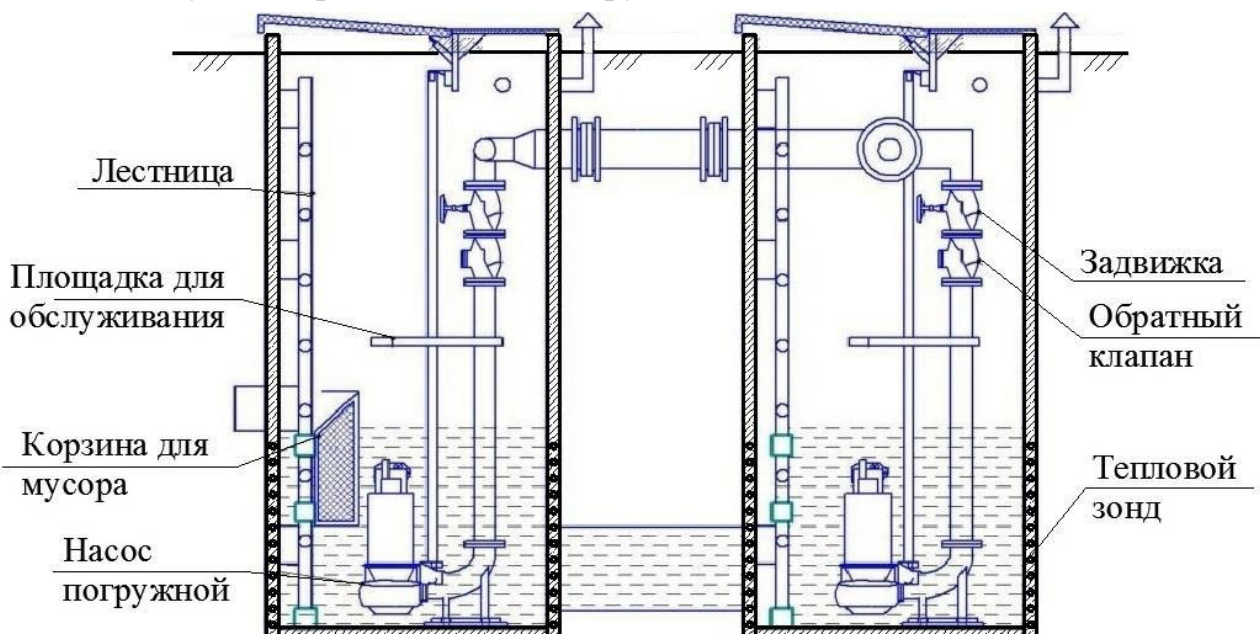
Типовая железобетонная канализационная насосная станция с устройством тепловых зондов
